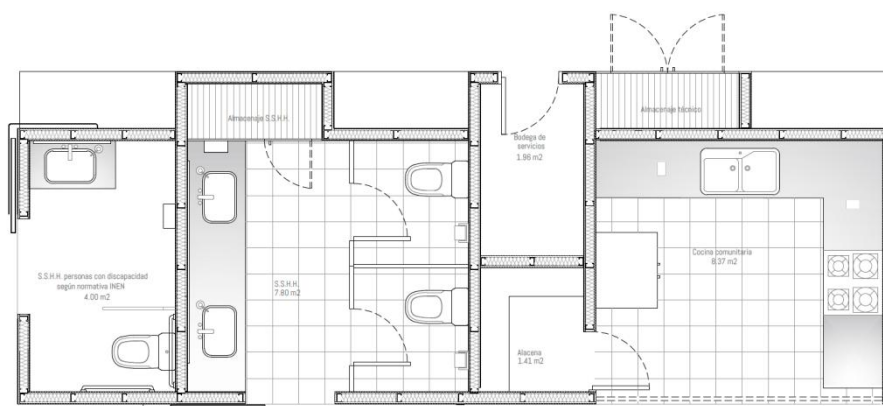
Planta de paquete de servicios de la segunda planta. Fuente: elaboración propia.
